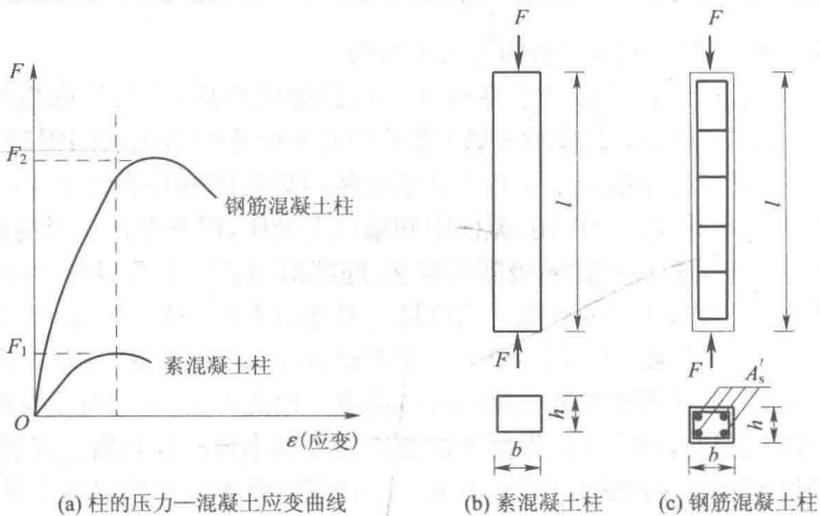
素混凝土和钢筋混凝土轴心受压构件的受力性能比较
